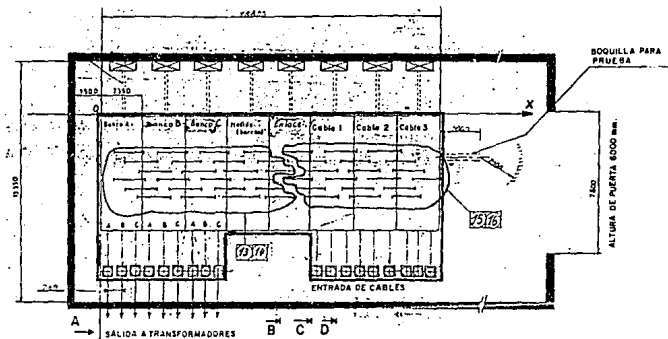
Vista general de planta de las celdas que componen la subestación.
